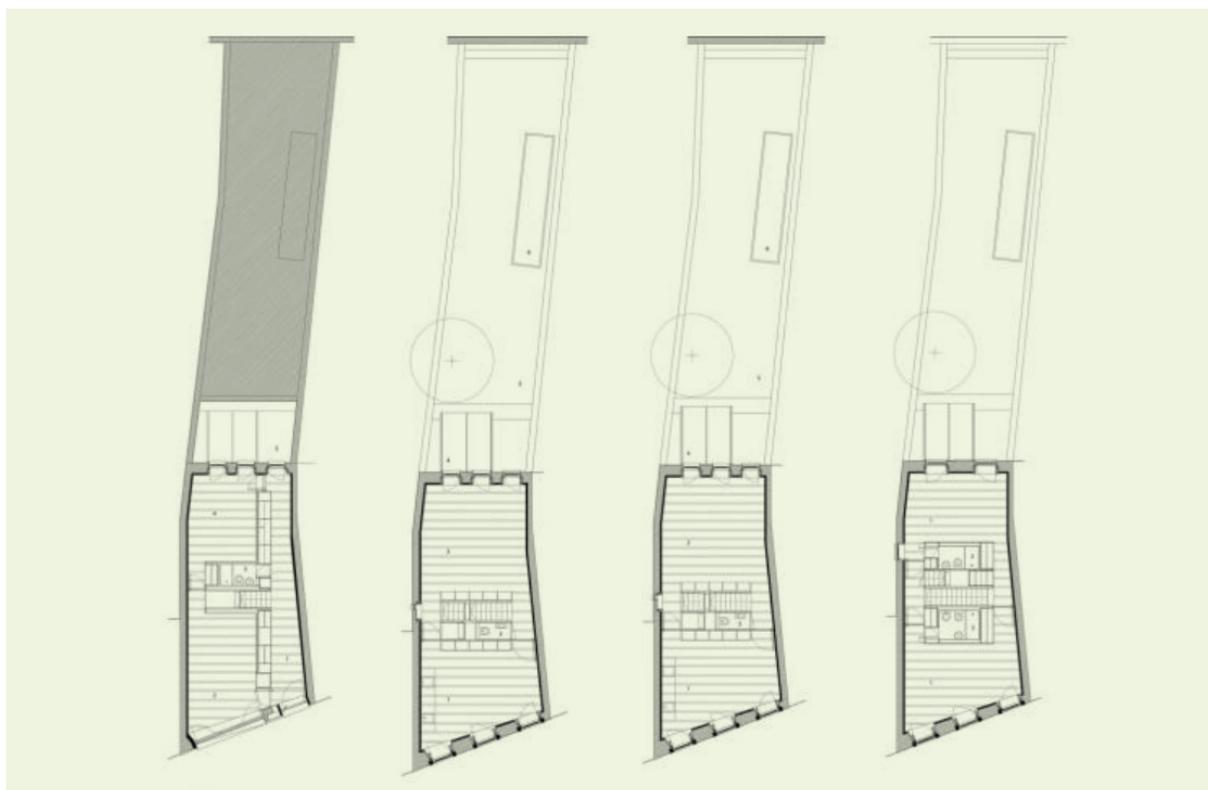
Plantas da cave; rés-do-chão; piso 1, piso 2 e piso 3 – Casa das Janelas Verdes
